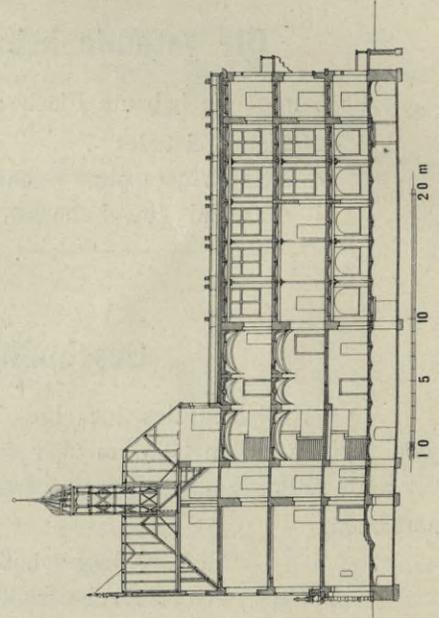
Hauptgebäude. Längenschnitt durch das Vordergebäude und den östlichen Laboratorienflügel.
